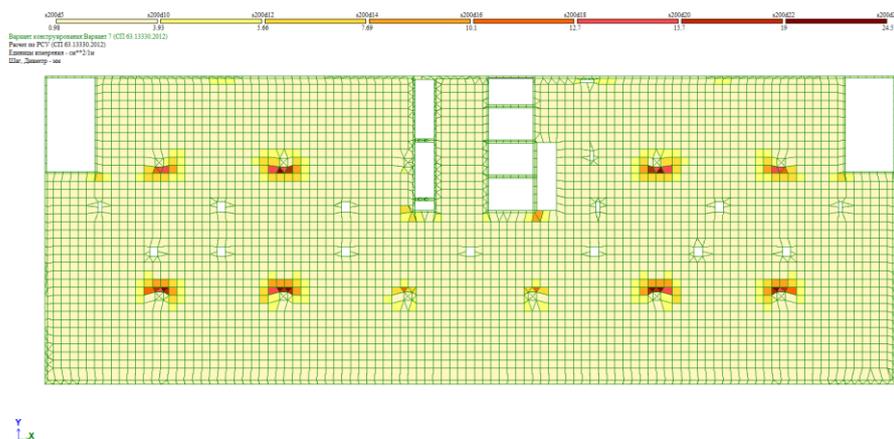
Площадь арматура на 1 п.м. по оси Y у верхней грани
